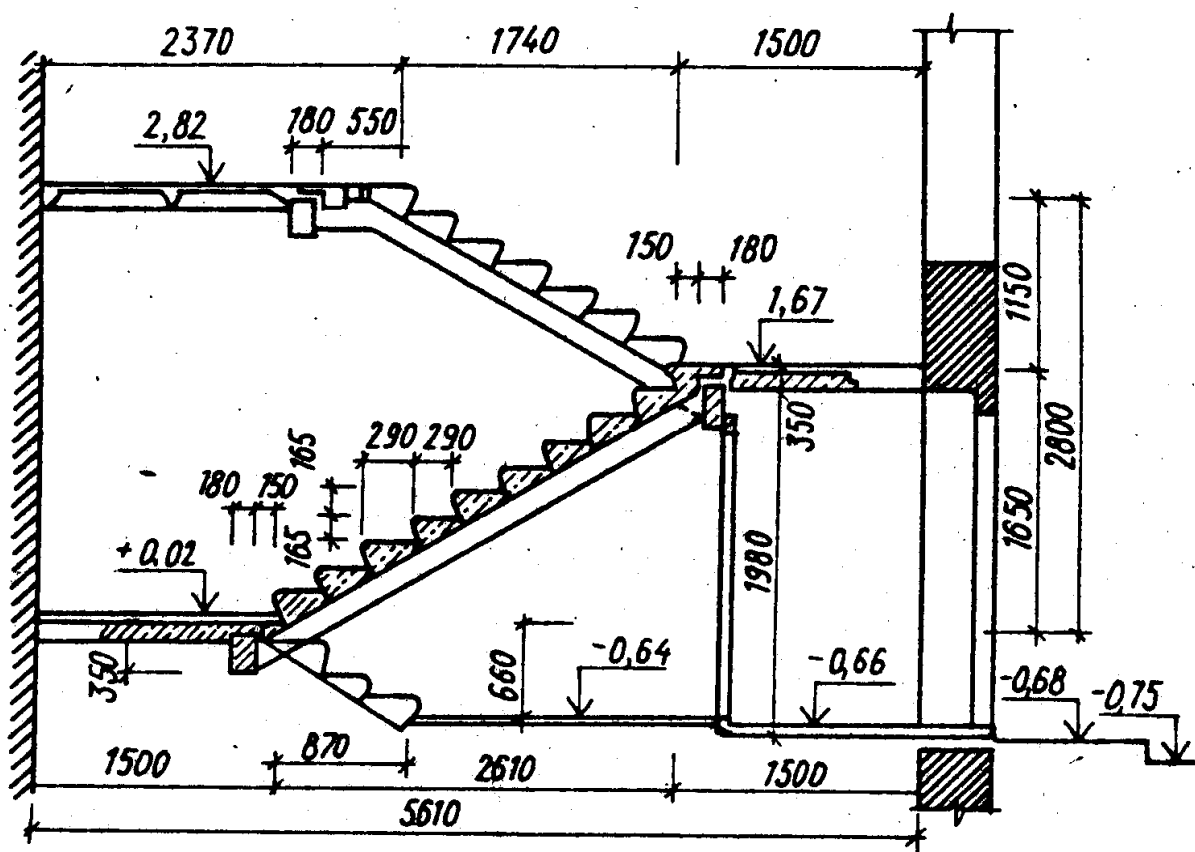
Схема сходів із збірних залізобетонних елементів
